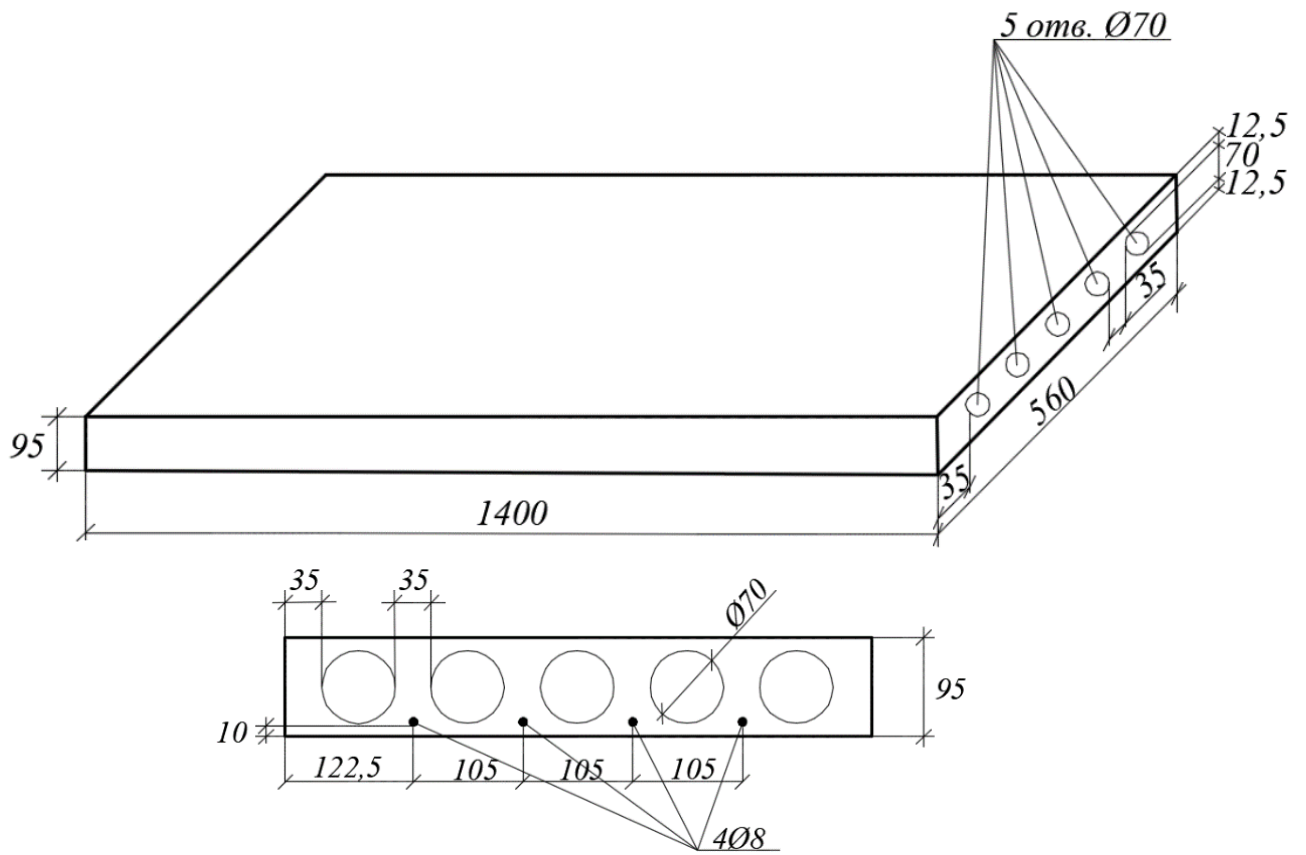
Модель залізобетонної багатопустотної плити перекриття
